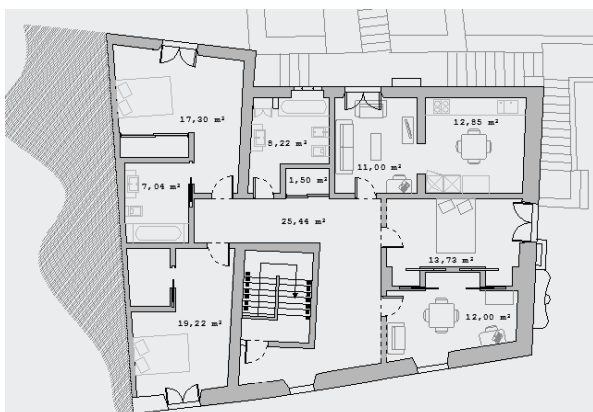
Proposta 1 para a planta de arquitetura do Piso 2
